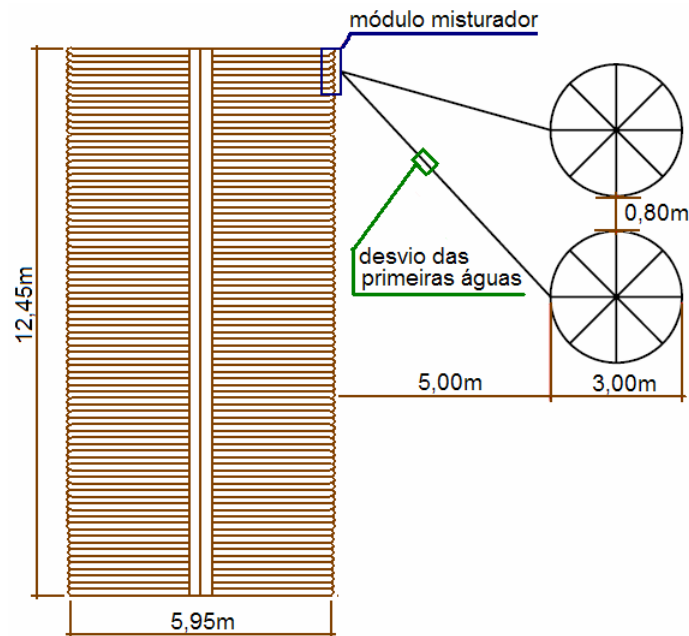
Projeto de instalação do modelo piloto na Escola.
